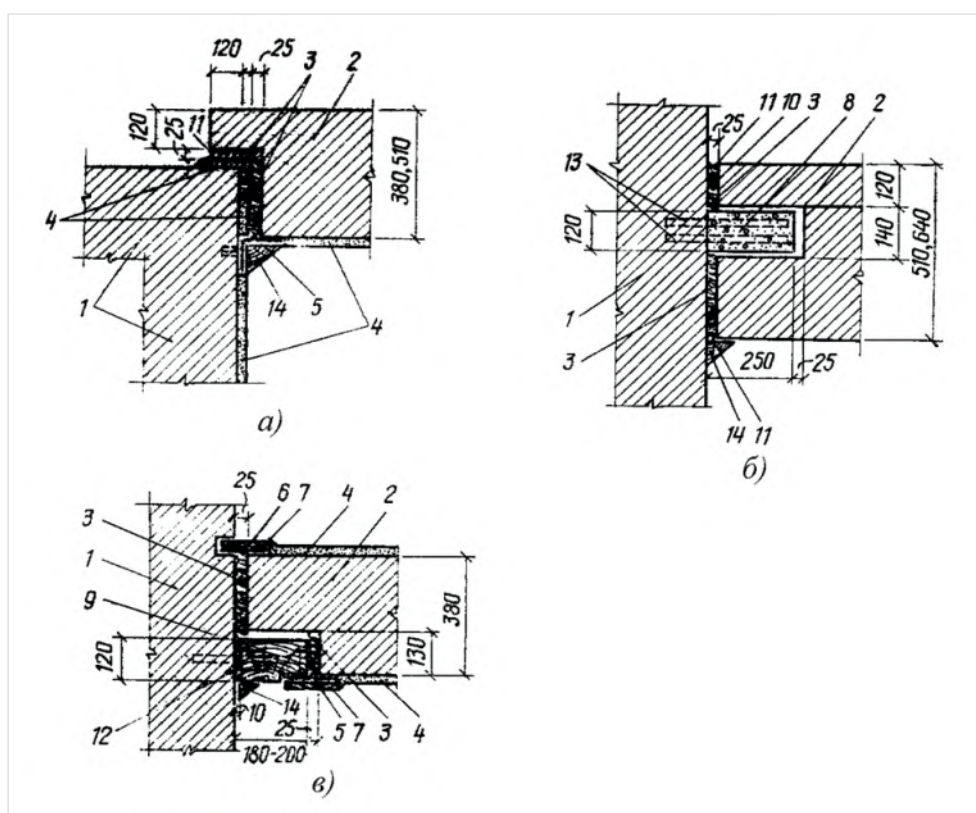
Соединение кирпичных стен пристройки с кирпичными или бетонными стенами существующего дома: а — угловое; б — с использованием легкогобетонной вставки; в — с использованием соединительного бруса (1 — стена существующего дома; 2 — стена пристройки; 3 — конопатка; 4 — штукатурка; 5 — пароизоляция; 6 — гидроизоляция; 7 — нащельник; 8 — легкогобетонная вставка; 9 — соединительный брус; 10 — пористый жгут; 11 — нетвердеющая мастика; 12 — пористая прокладка; 13 — металлический костыль; 14 — накладка)
